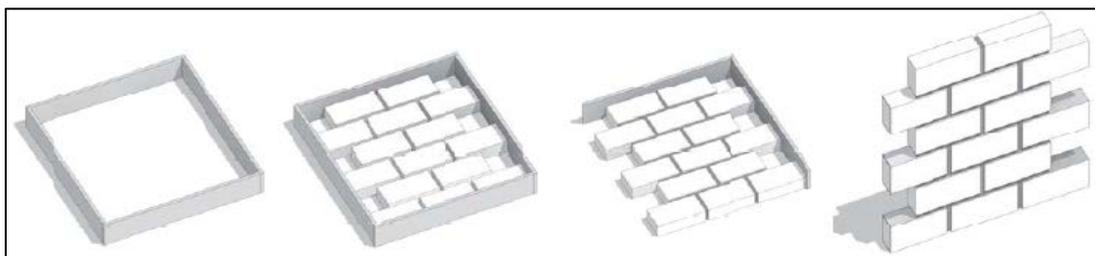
Gabinete de Arquitectura, Paneles Cerámicos Prefabricados, Proceso Constructivo.
